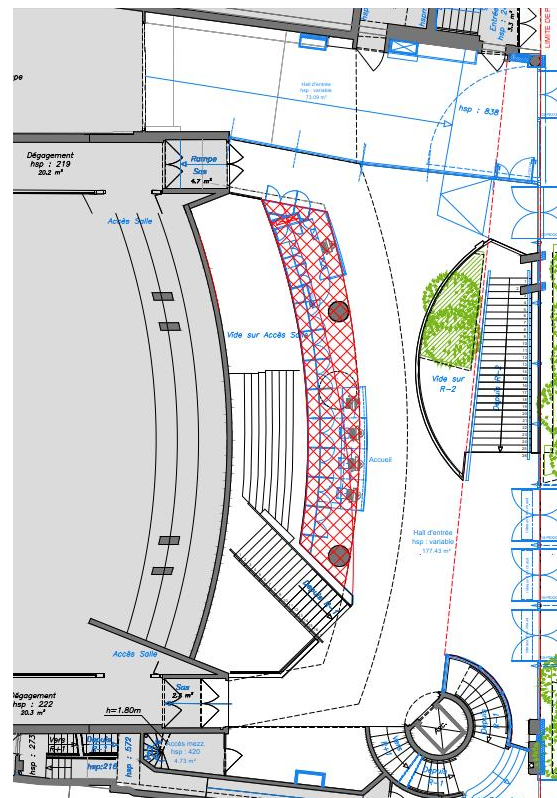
Plan du niveau RDC – Surface couverte par le système SPK
